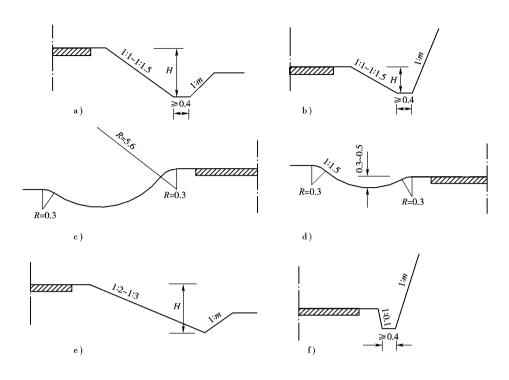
边沟横断面示意图(尺寸单位 m) a)、b)梯形 ɛ)、d)蝶形 ɛ)三角形 ґ)矩形
